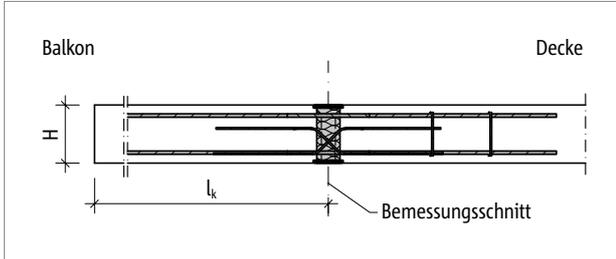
Schöck Isokorb® T Typ DP: Statisches System
